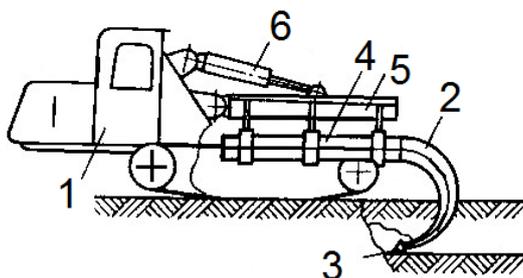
Виброрыхлитель: 1 - базовая машина; 2 - стойка; 3 - зуб; 4 - стержневой магнитострикционный вибровозбудитель; 5 - рама; 6 - гидроцилиндр управления
